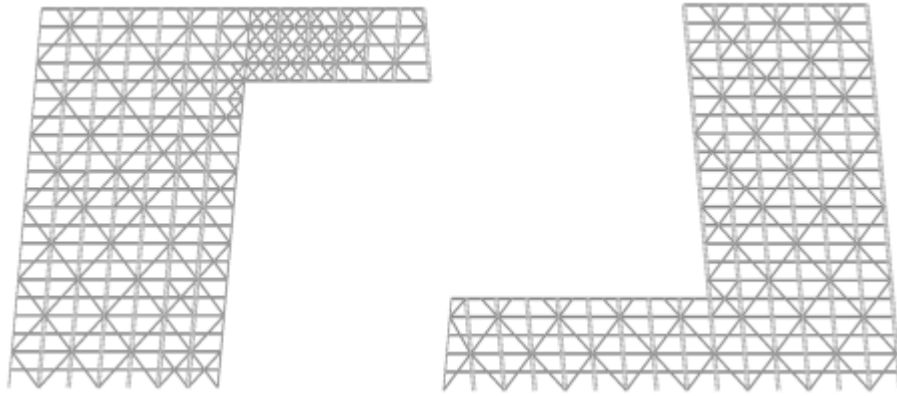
Переріз розрахункової схеми будівлі по зовнішньому контуру будівлі ПК SCAD
